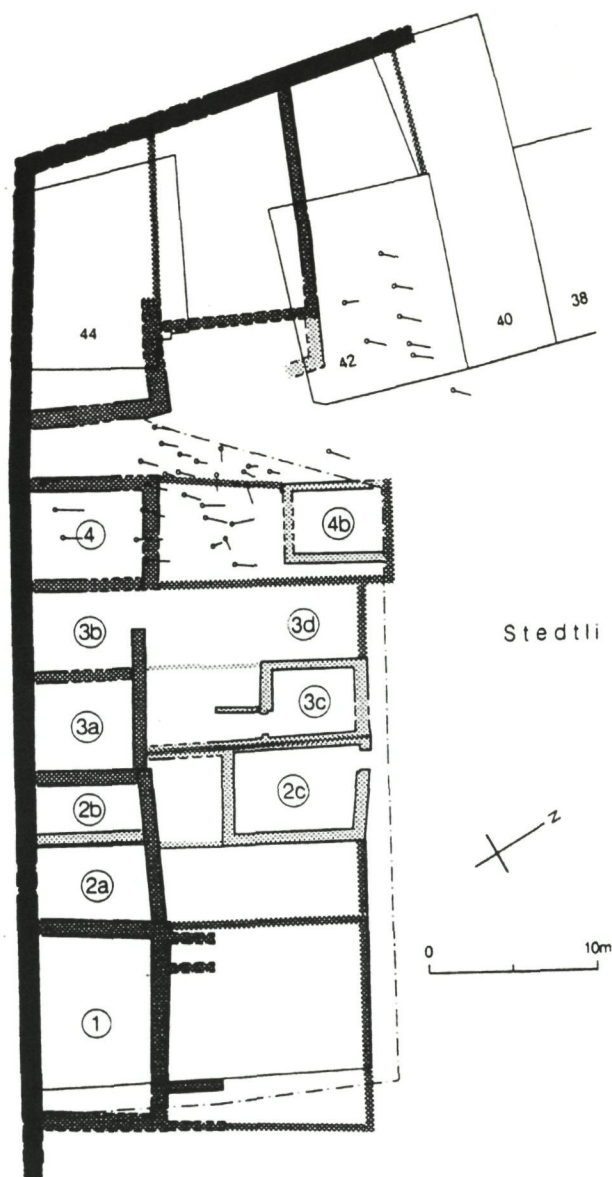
Unterseen BE. Planausschnitt der westlichen Häuserzeile mit Grundrissen der ersten Bebauung. M 1:400.
